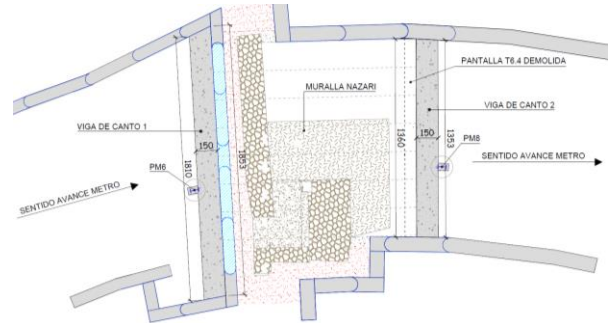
Vista en planta de pantallas y posición prevista de muralla en proyecto.
